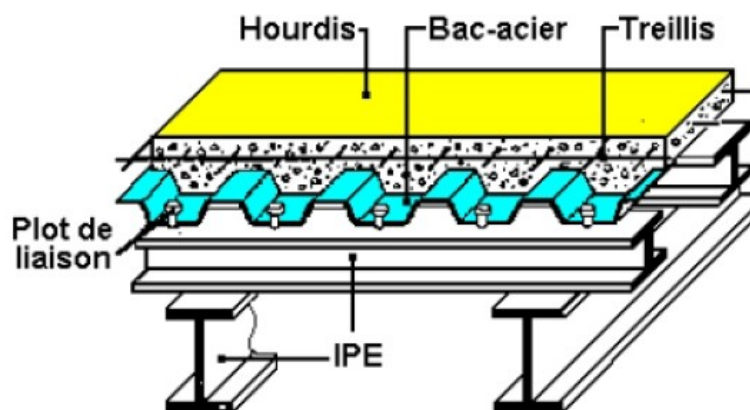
Plancher à corps creux et à poutrelles métalliques
